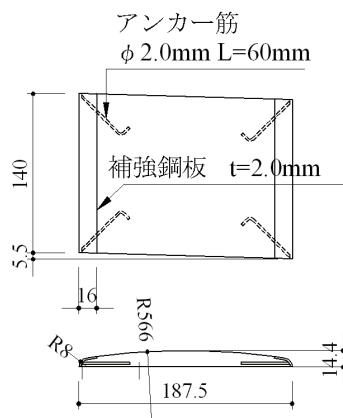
薄型セグメント詳細図 (単位 mm)
